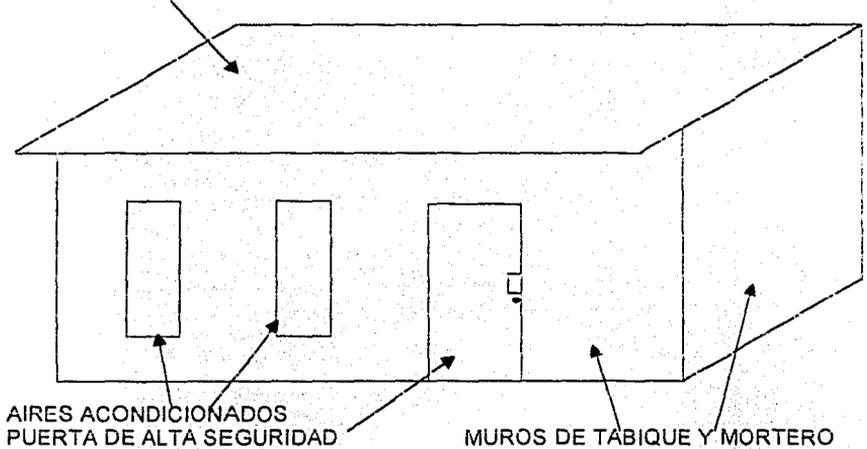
SHELTER ELABORADO EN SITIO
